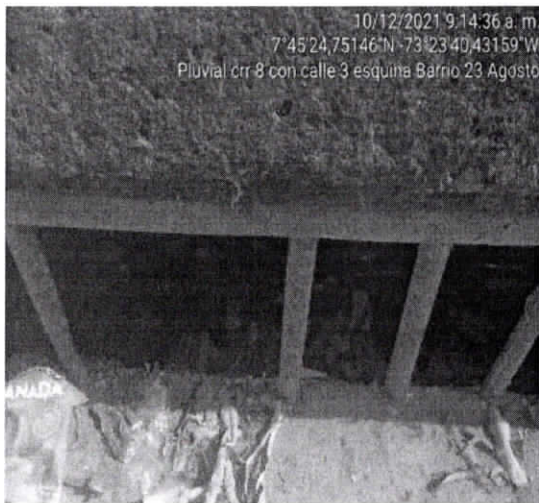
Alcantarillado Pluvial Crr 8 con calle 3 esquina, barrio 23 de Agosto.
